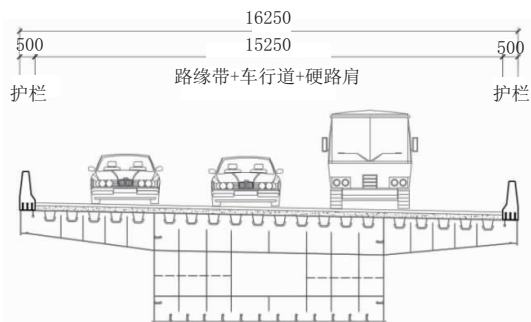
上海G1503高速公路跨吴淞江大桥横断面图(单位:mm)
